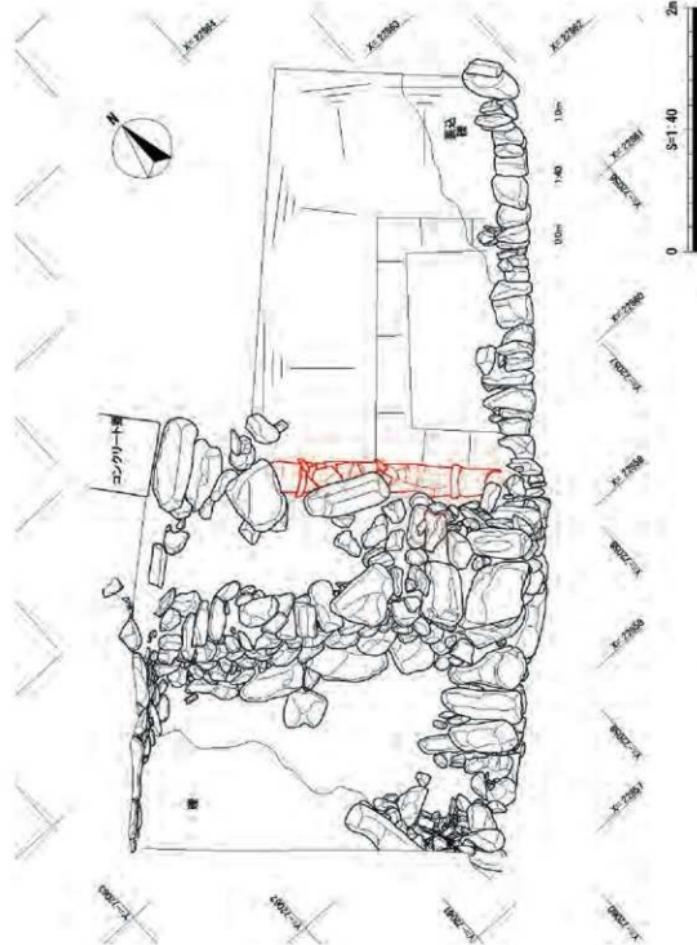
石垣 A・B 平面図（吐水口背面土管平面図）
